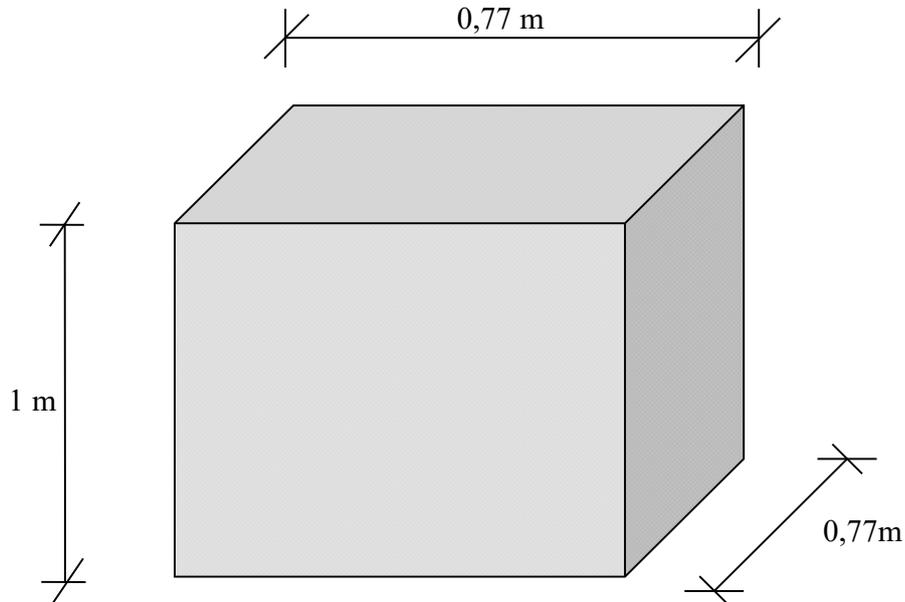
DIMENSIONES DEL TANQUE DE COAGULACIÓN DISEÑADO
